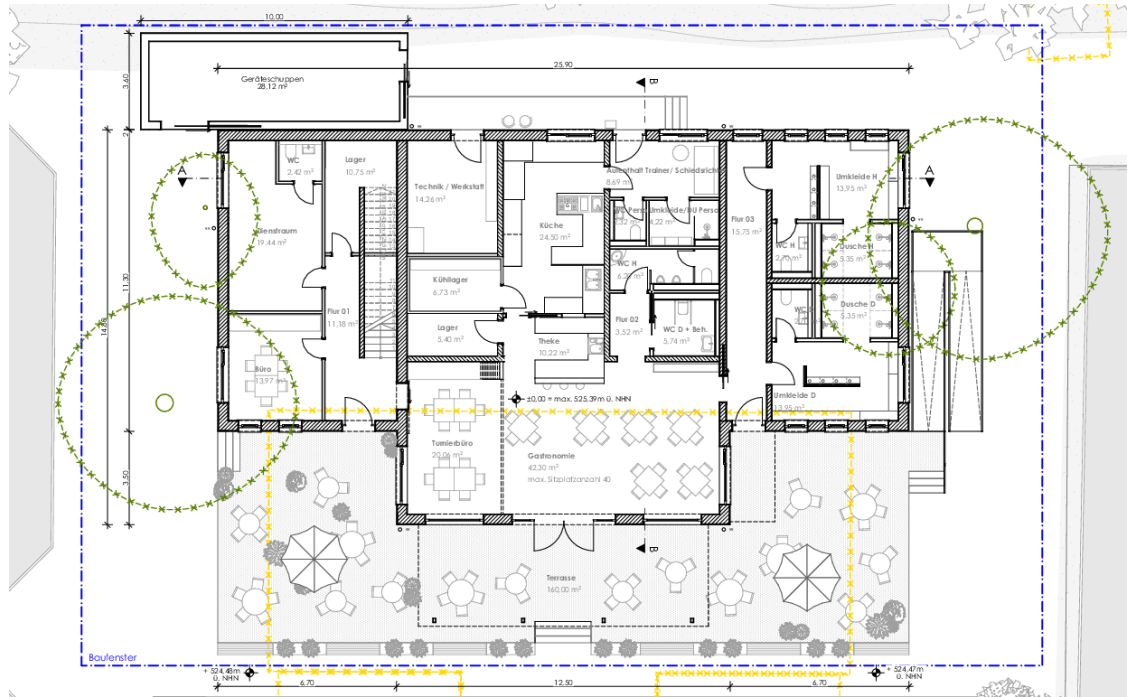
Grundriss EG, Quelle: Anderer Architekten, vom 09.01.2024
